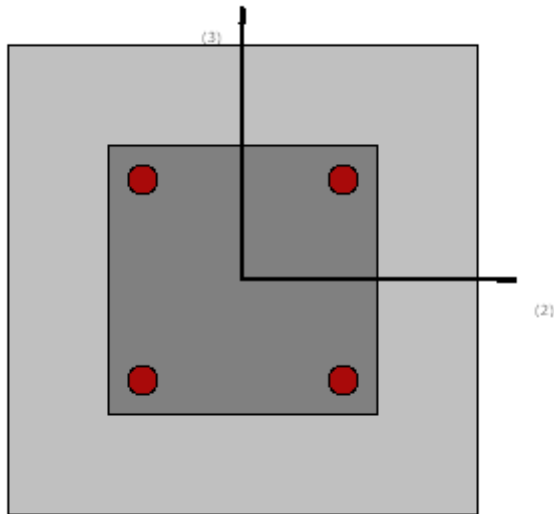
Sección transversal viga de amarre (Seismosoft, 2013)
